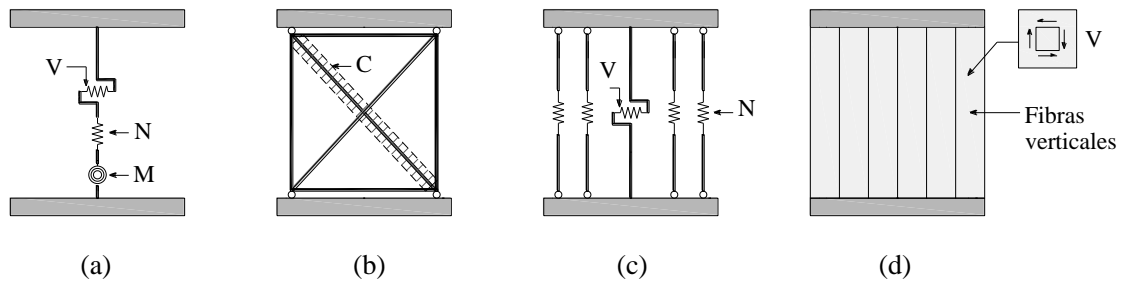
Modelos disponibles para modelar muros de concreto reforzado : (a) viga-columna, (b) modelo de armadura, (c) modelo de elementos verticales múltiples, (d) placa con fibras verticales PERFORM 3D
